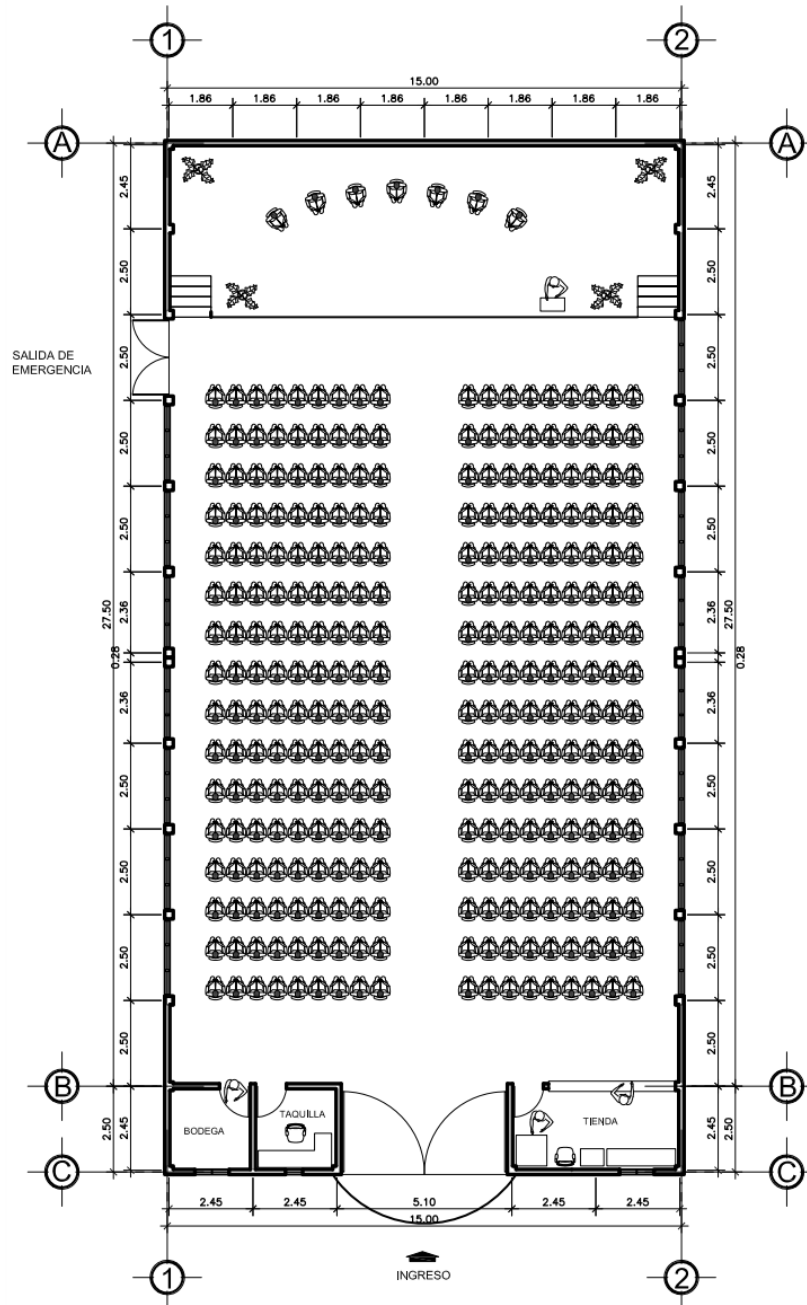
Planta Arquitectónica primer nivel auditorium. Fuente: Trabajo de grado, Universidad de San Carlos, Guatemala.
